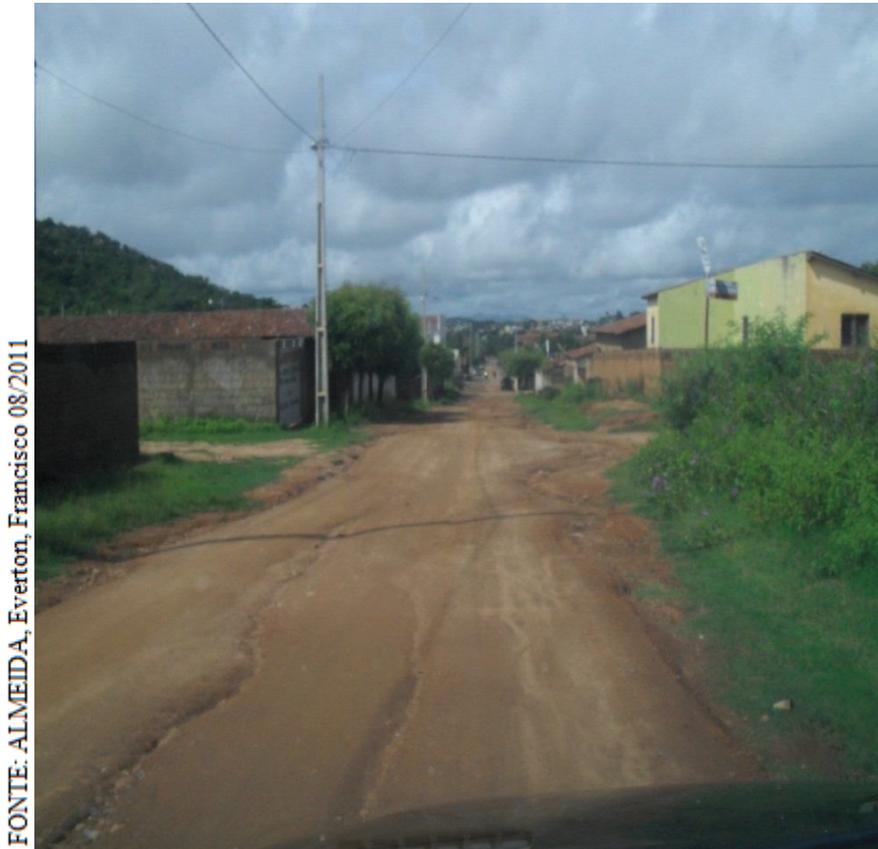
Rua sem pavimentação localizada no bairro da Rocinha.
